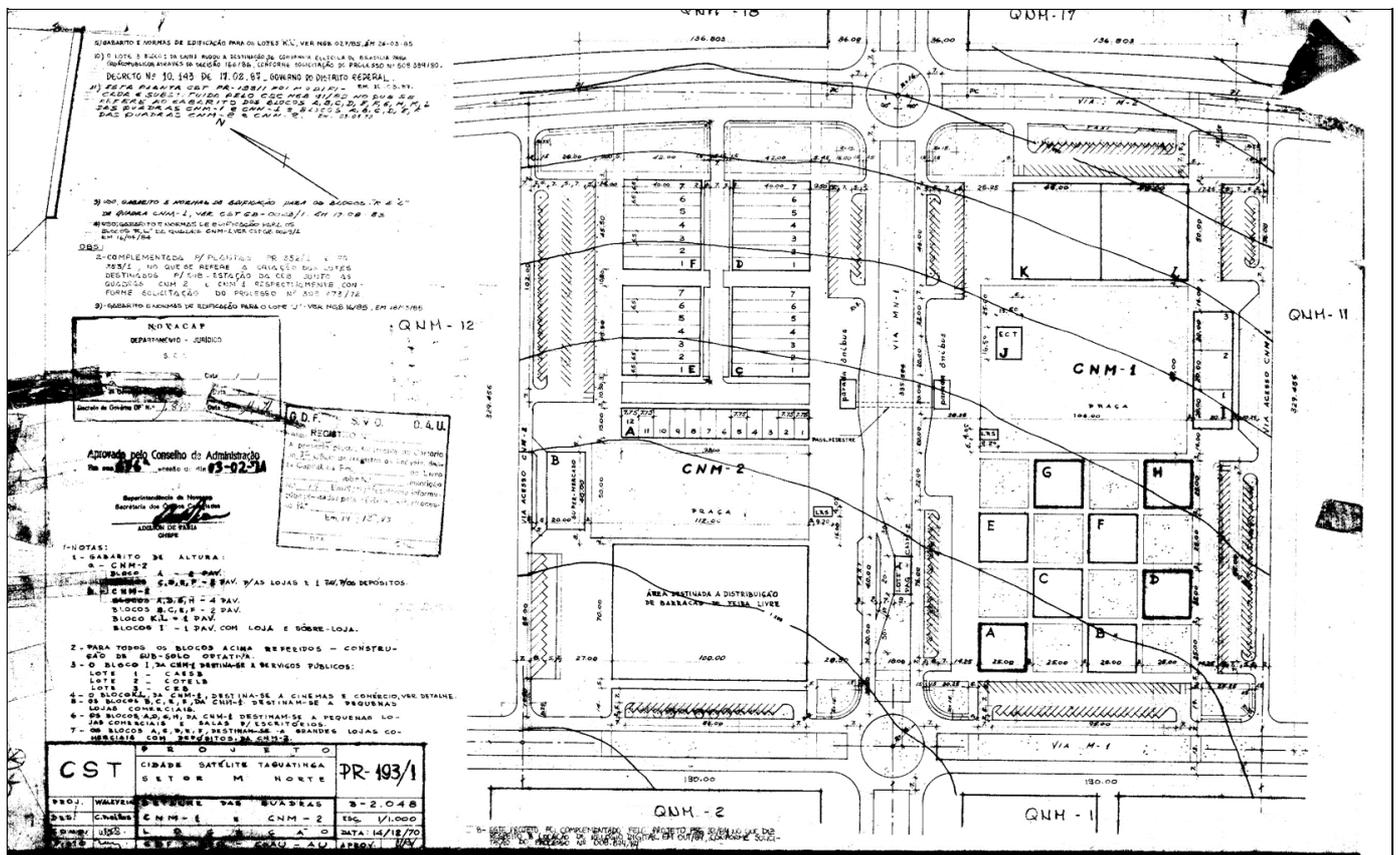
Planta Registrada CST 163/1, fonte: Mapoteca/SEDUH
